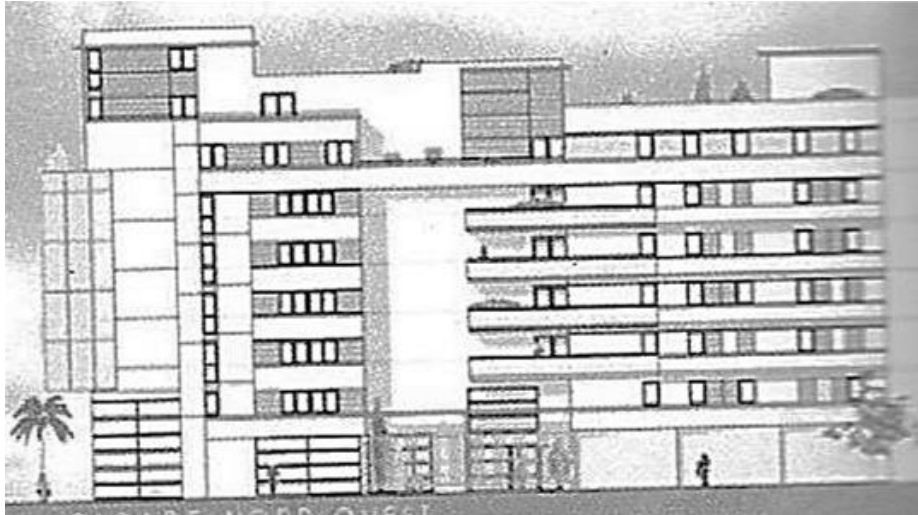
Façade Nord-Ouest d'une résidence « les Barques » à Montpellier, Architecte Bedeau, 2000.
